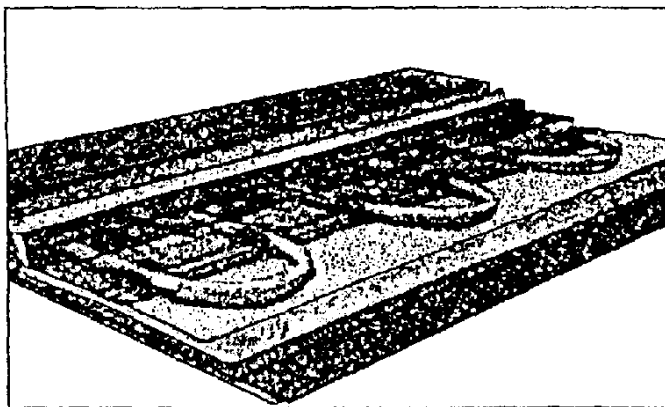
Общий вид конструкции панельной обогреваемой стяжки с встроенной системой отопления
